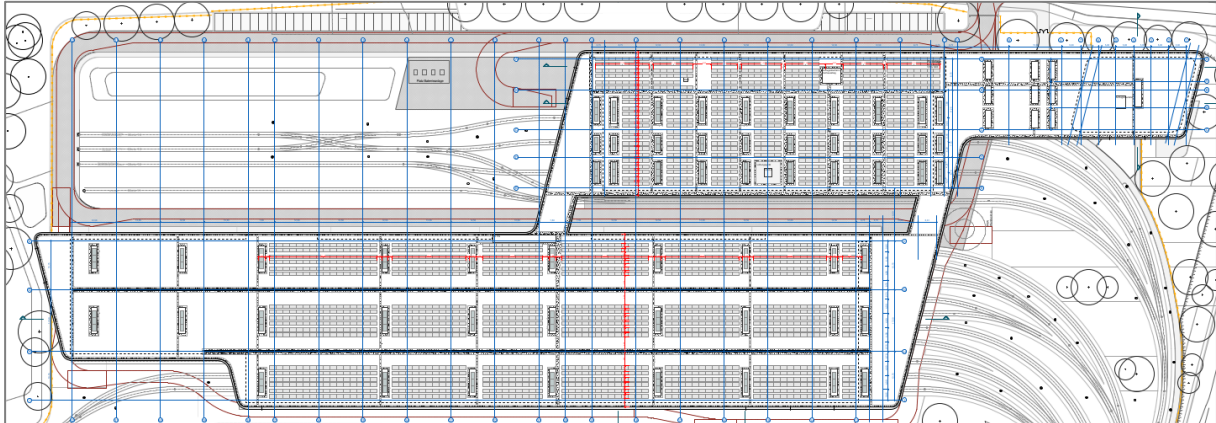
Dachaufsicht Dienst-/Sozialgebäude, Wasch-/Wartungshalle, Abstellhalle
